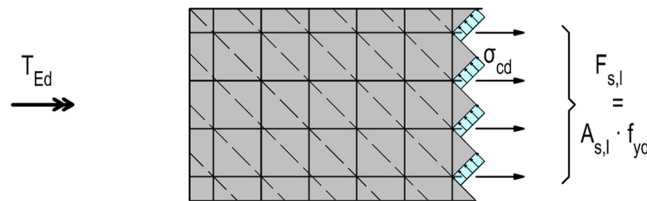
Reine Torsion – Stahlbeton aus [79]
